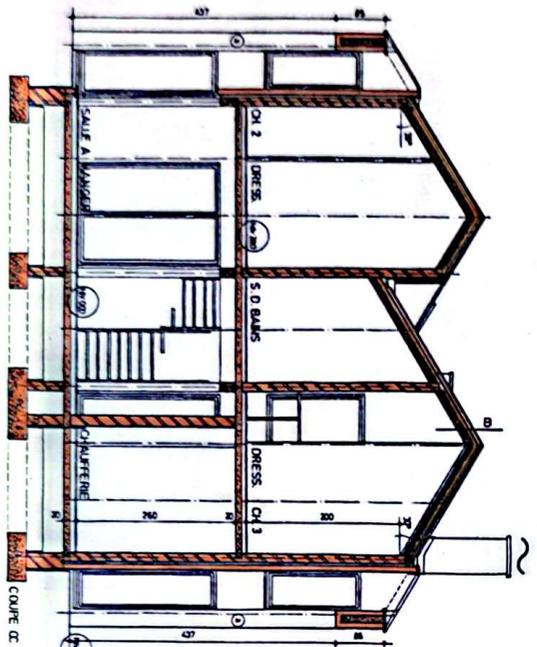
12 13 Les plans de demande d'autorisation de bâtir et d'exécution. Plans rez et étage. Coupes A, A' C, C' et les façades.
